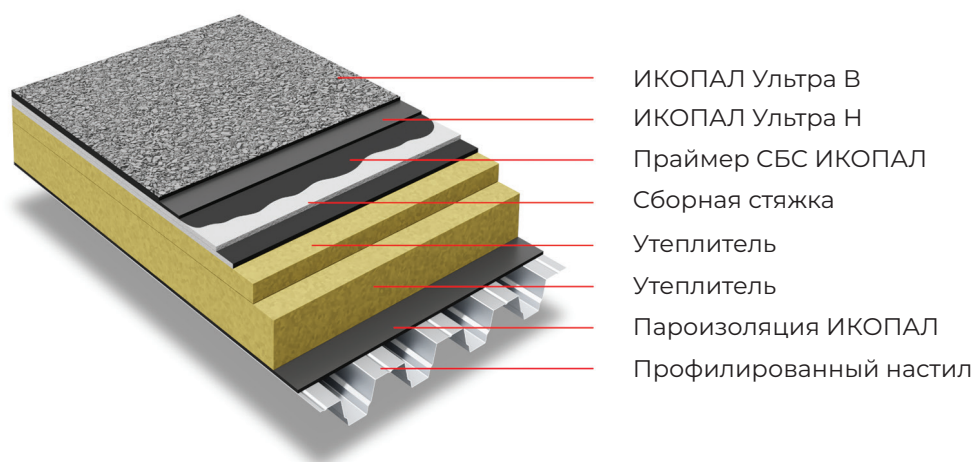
Вариант неэксплуатируемой кровли с двухслойным кровельным ковром
